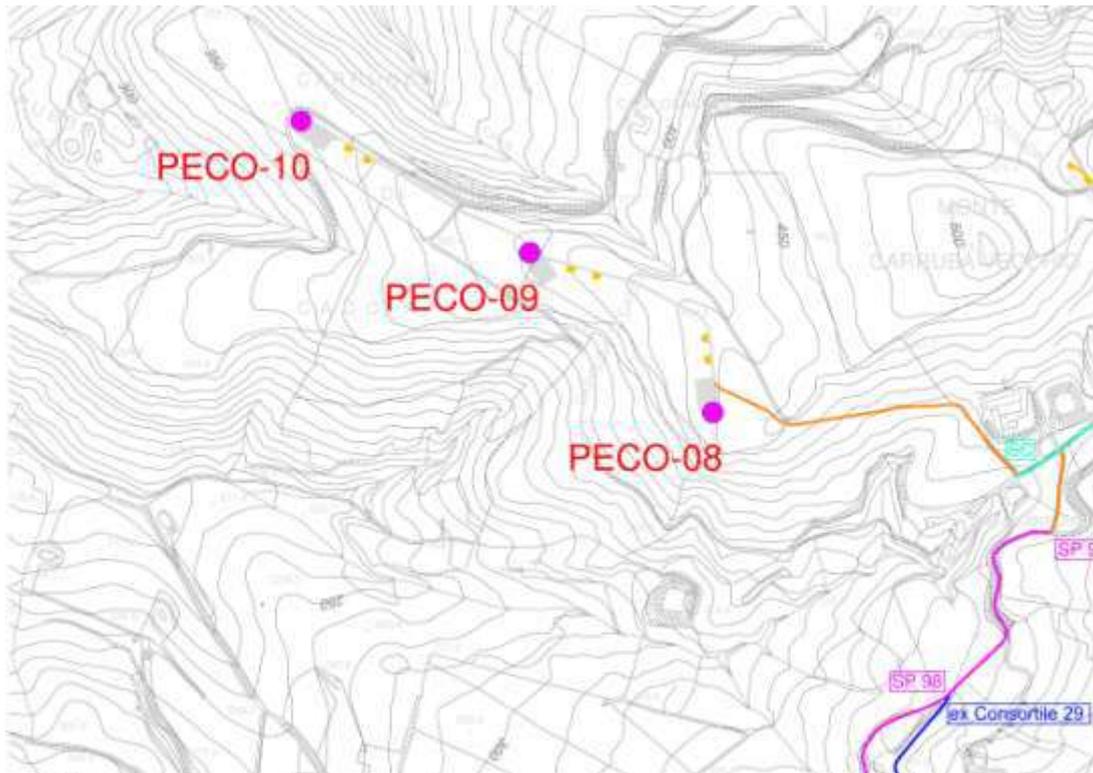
, 6.5, 6.6, 6.7- Stralci planimetrici delle strade di cantiere
